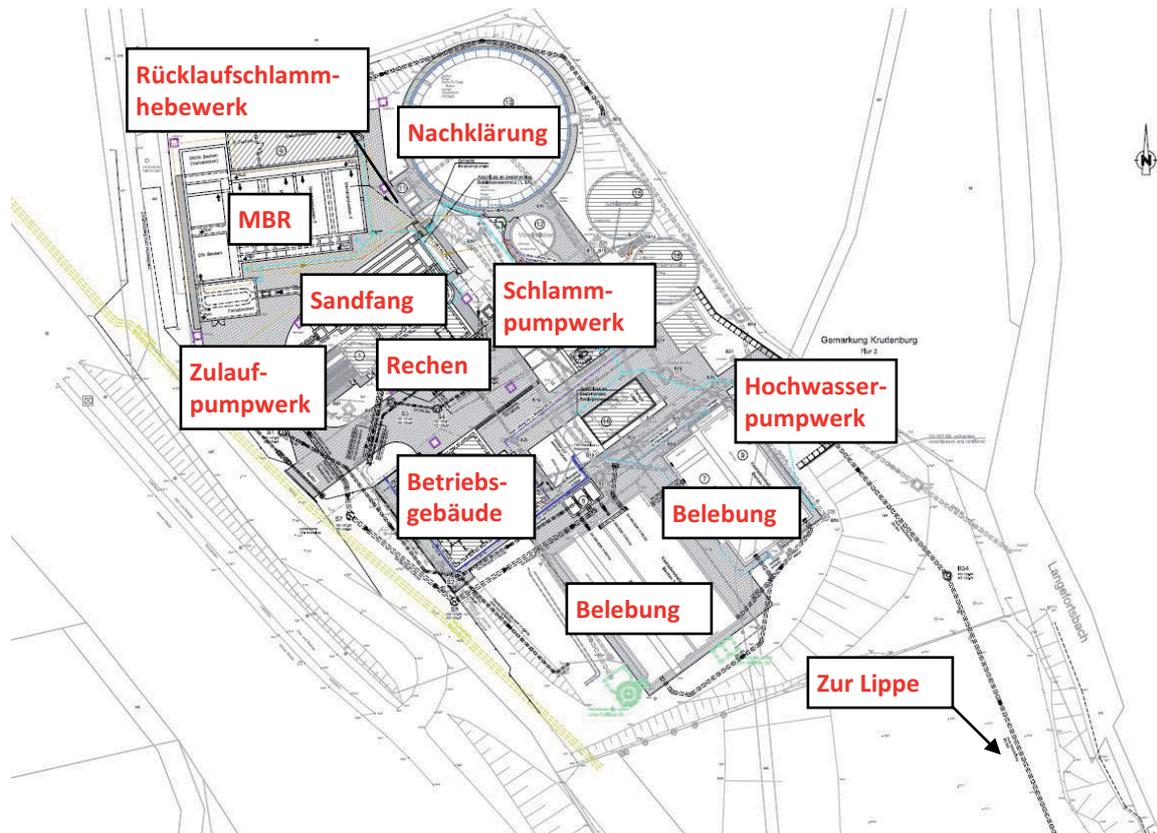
Gesamtlageplan der Kläranlage Hünxe [Dahlem, 2011]
